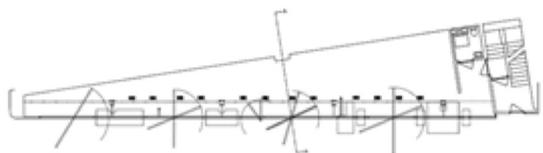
Planta arquitectónica presencia y ausencia muro. Porosidad.
